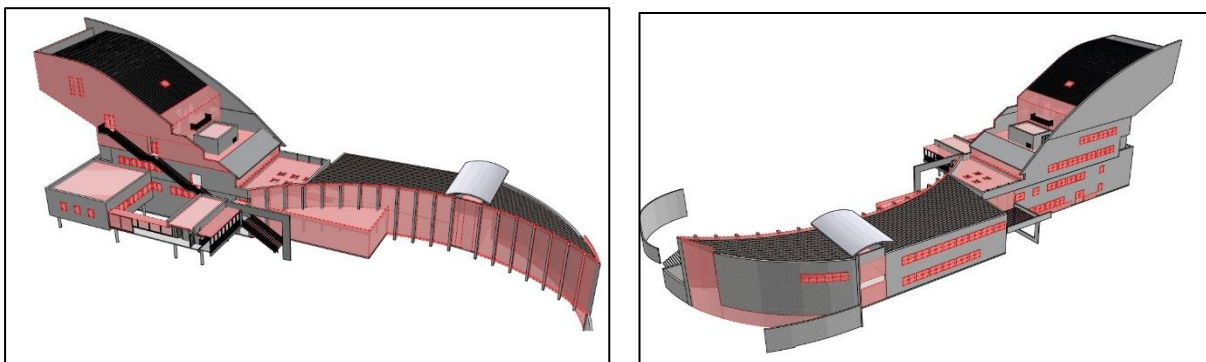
Repérage des volumes à déconstruire du bâtiment E selon plan PRO PADW
